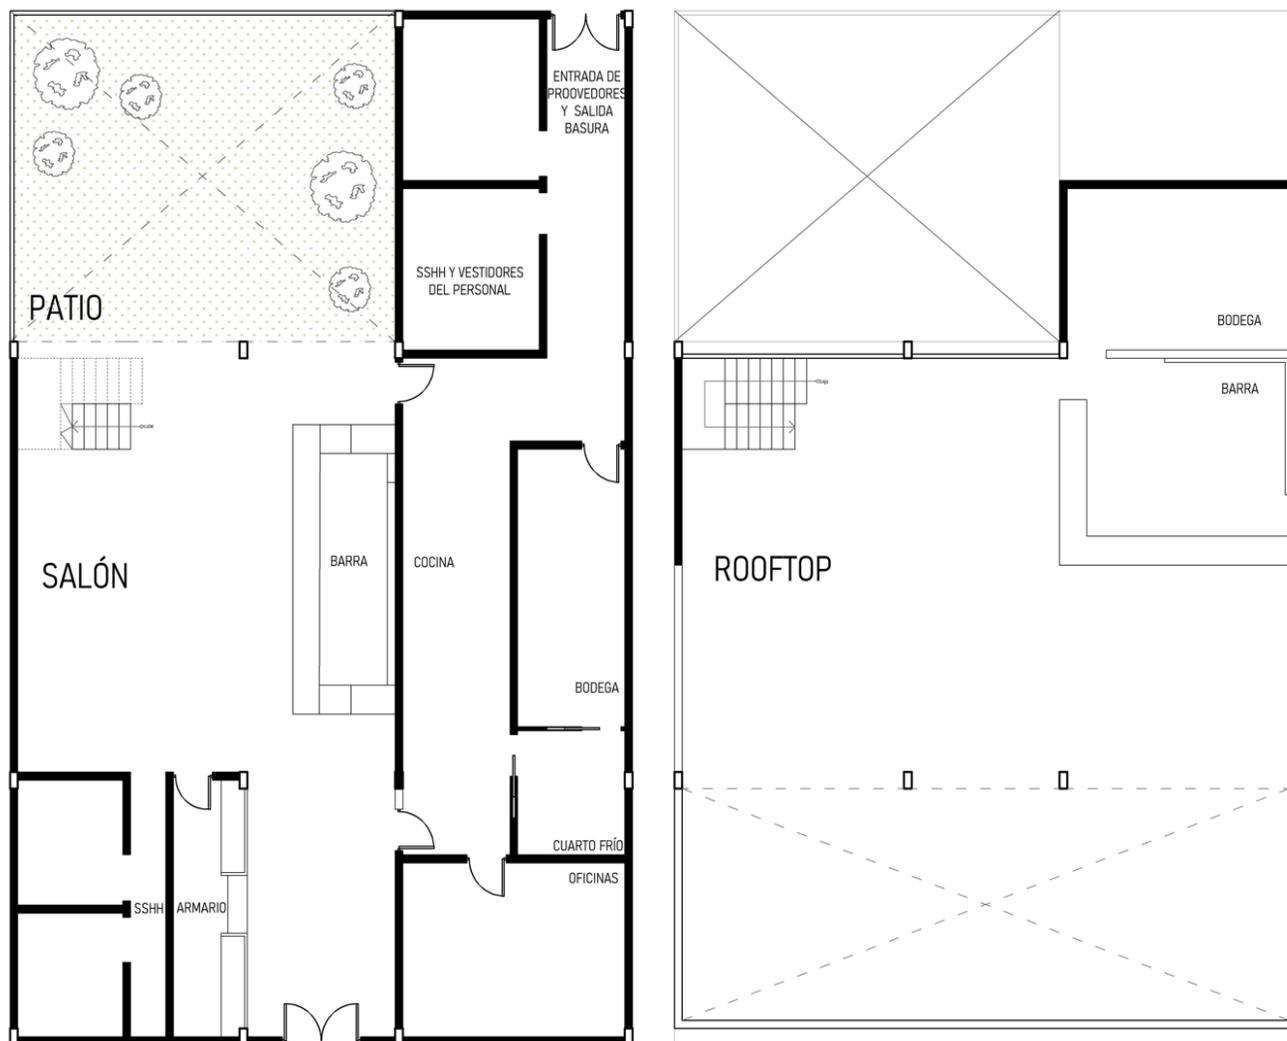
Distribución de espacio Planta Baja y Planta Alta
